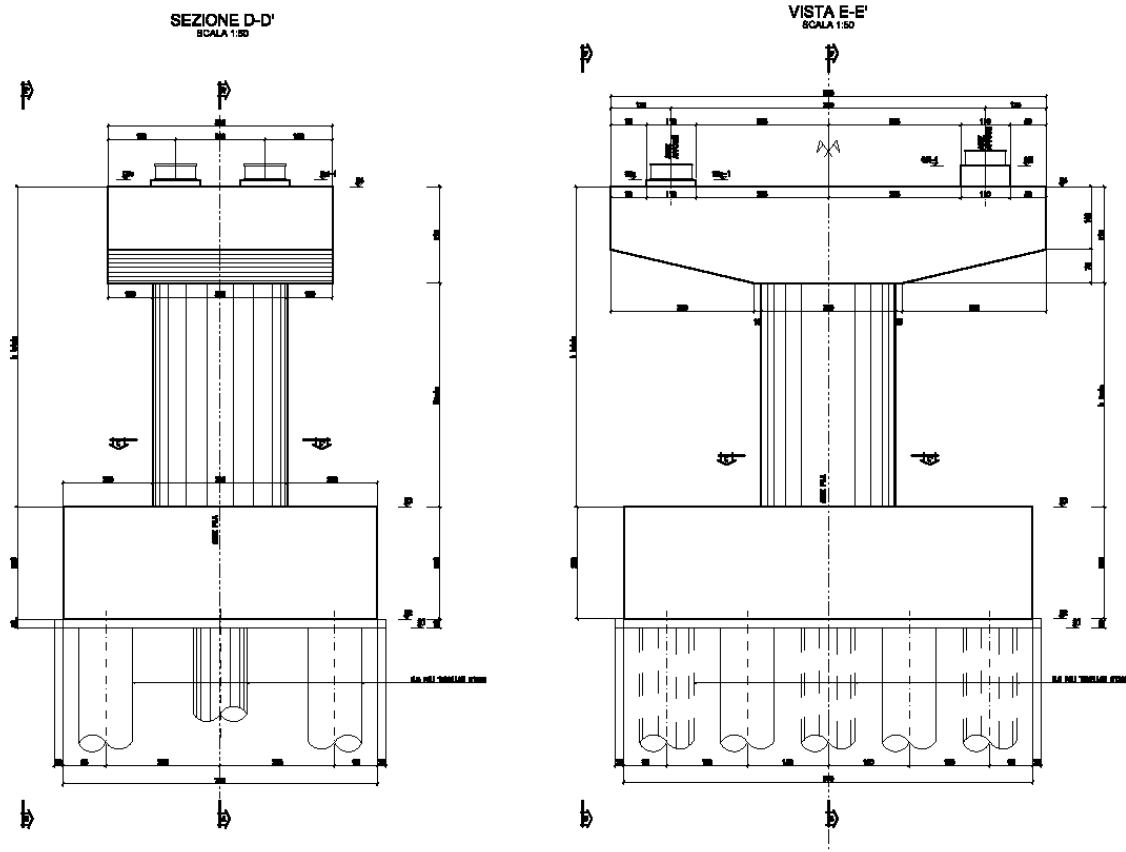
Prospetti (frontale e laterale) della pila in corrispondenza del giunto.
